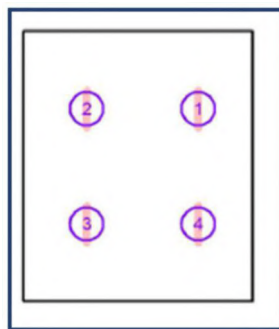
Ubicación en planta de las luminarias WT120C L600 1xLED18S/840 (PHILIPS)
